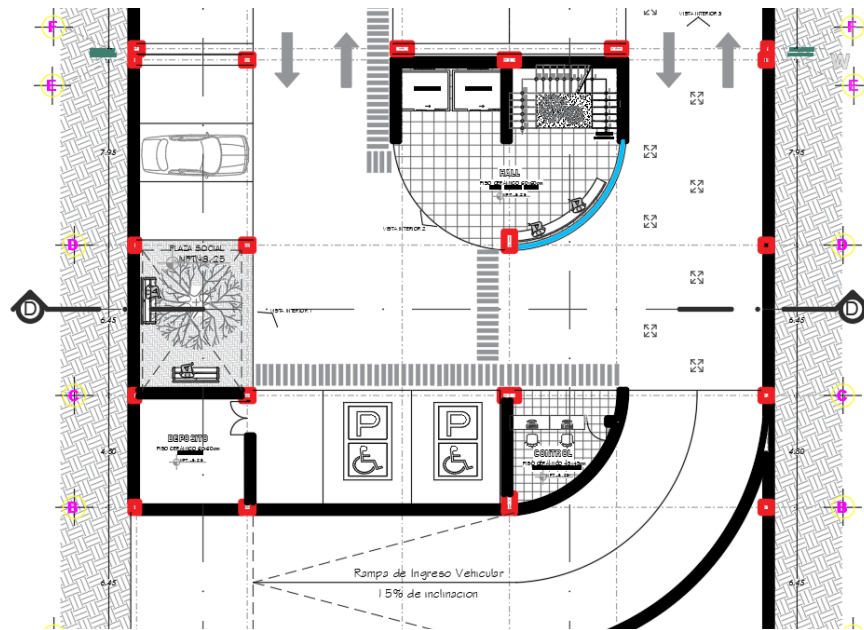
Sección de desarrollo estructural – Sótano, Estacionamiento.
